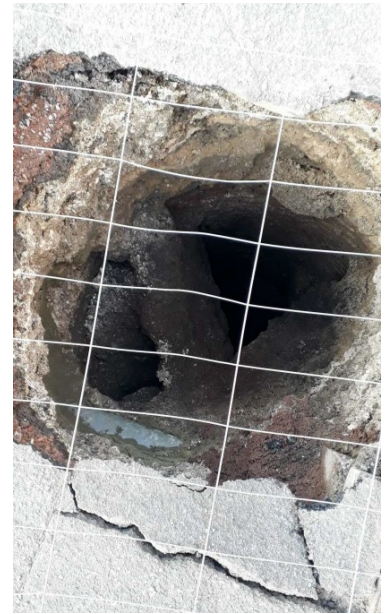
Débouillage de puits sur le site de l'ESPE d'Arras. Source: Mairie d'Arras (ARR364)
